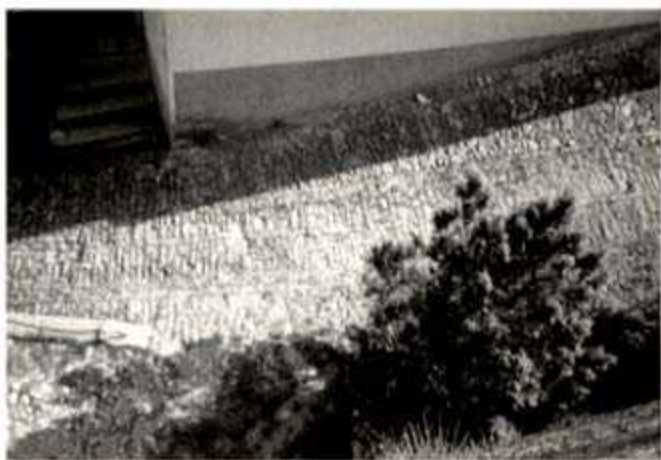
Boenti (Te), pavimentazione in pietra con "rotone" centrale (foto C. Casilli 1995).
